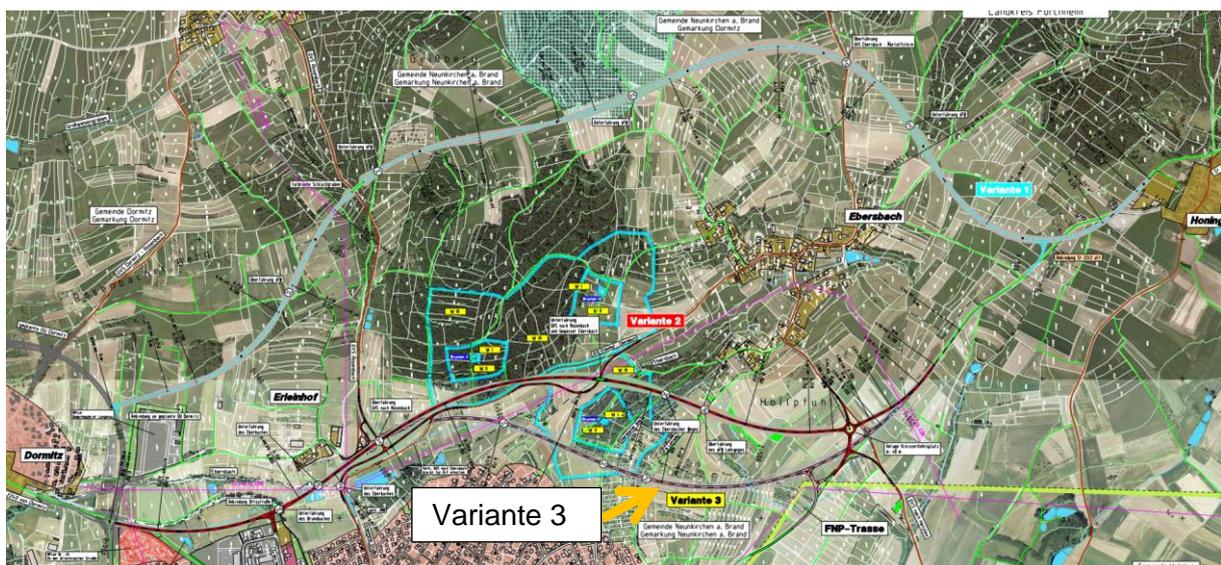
Ausschnitt aus Anlage 1: Lageplan der Varianten im Zuge Vorentwurf
